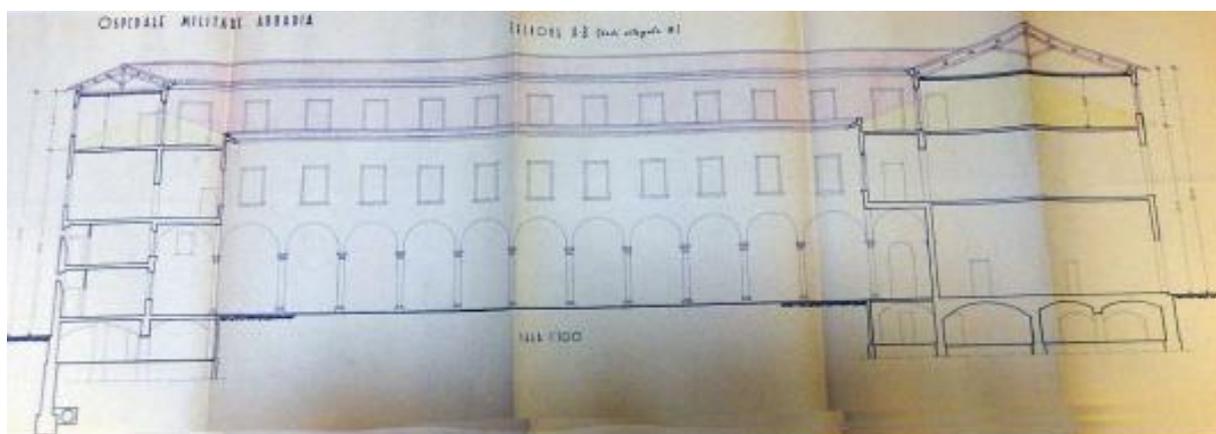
Sezione longitudinale sul chiostro dell'intervento di sopraelevazione del secondo piano (in giallo sono riportati i profili dei tetti esistenti da demolire)
